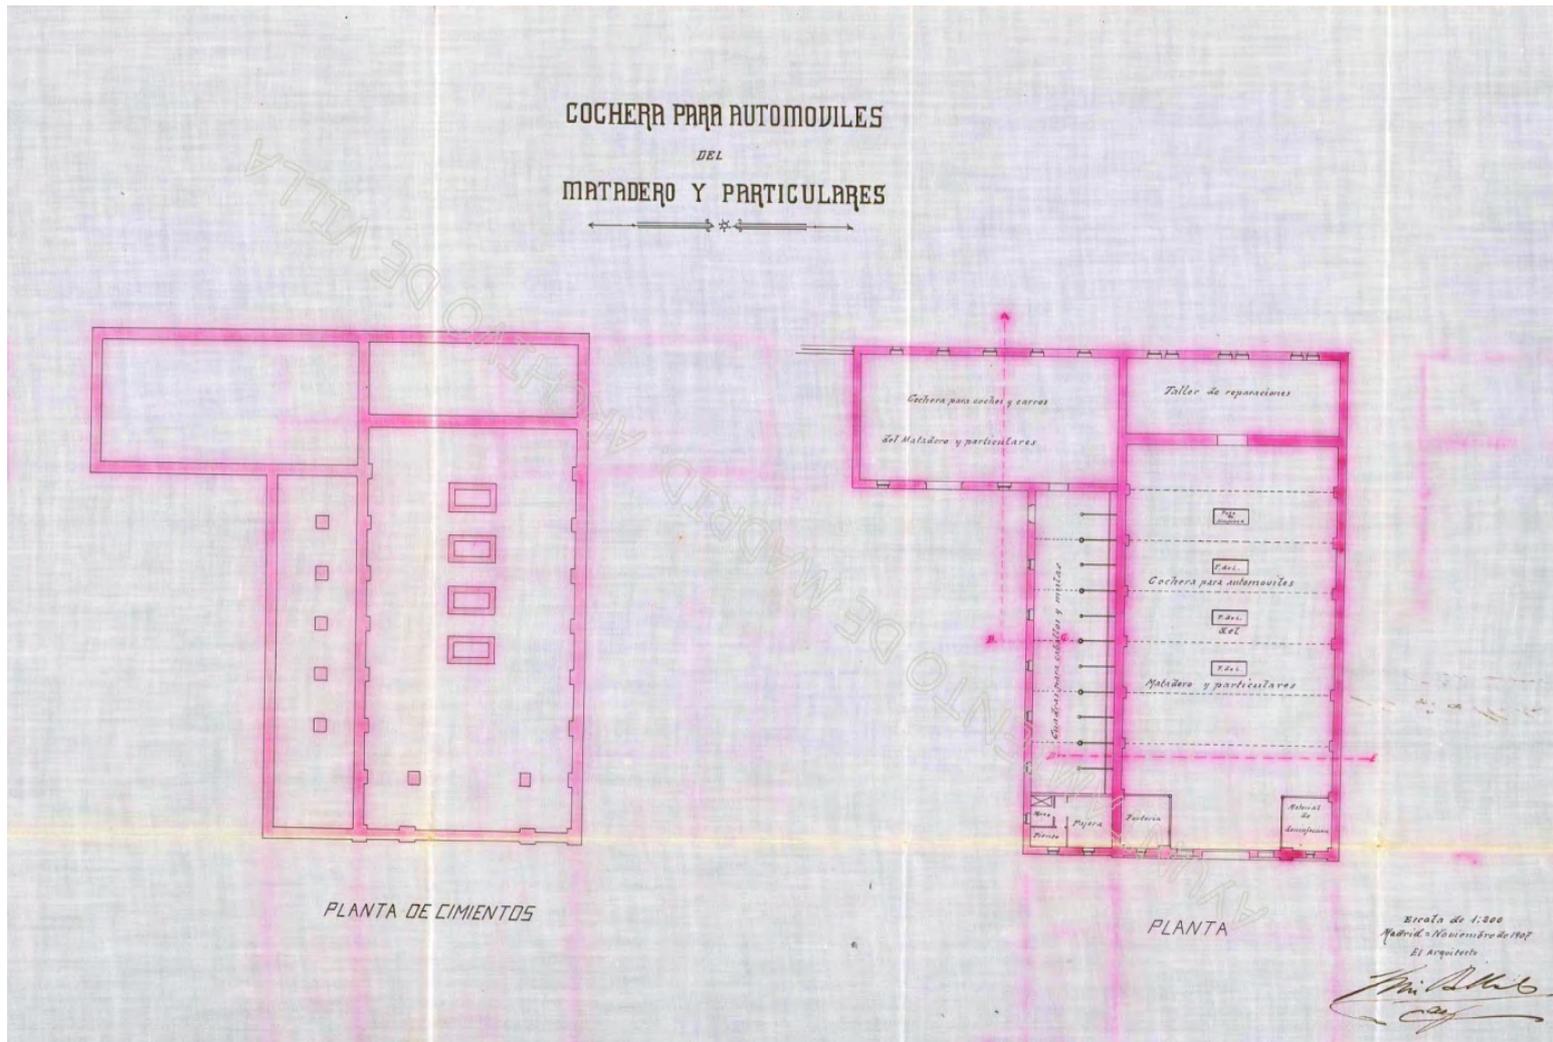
garagem, plantas. Imagem: Archivo de la Villa, Madrid.
